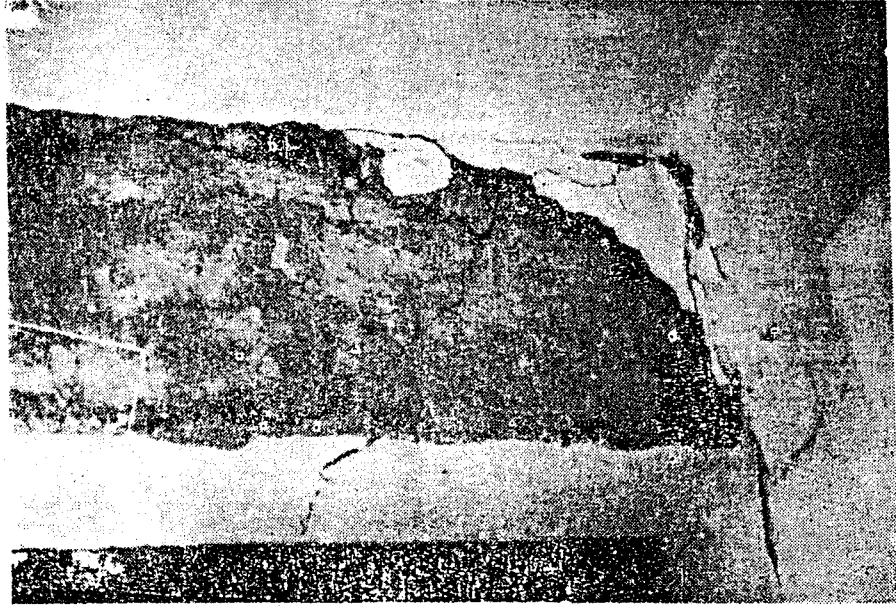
Köşe kolonda kesme kırılması hasarı [16]
